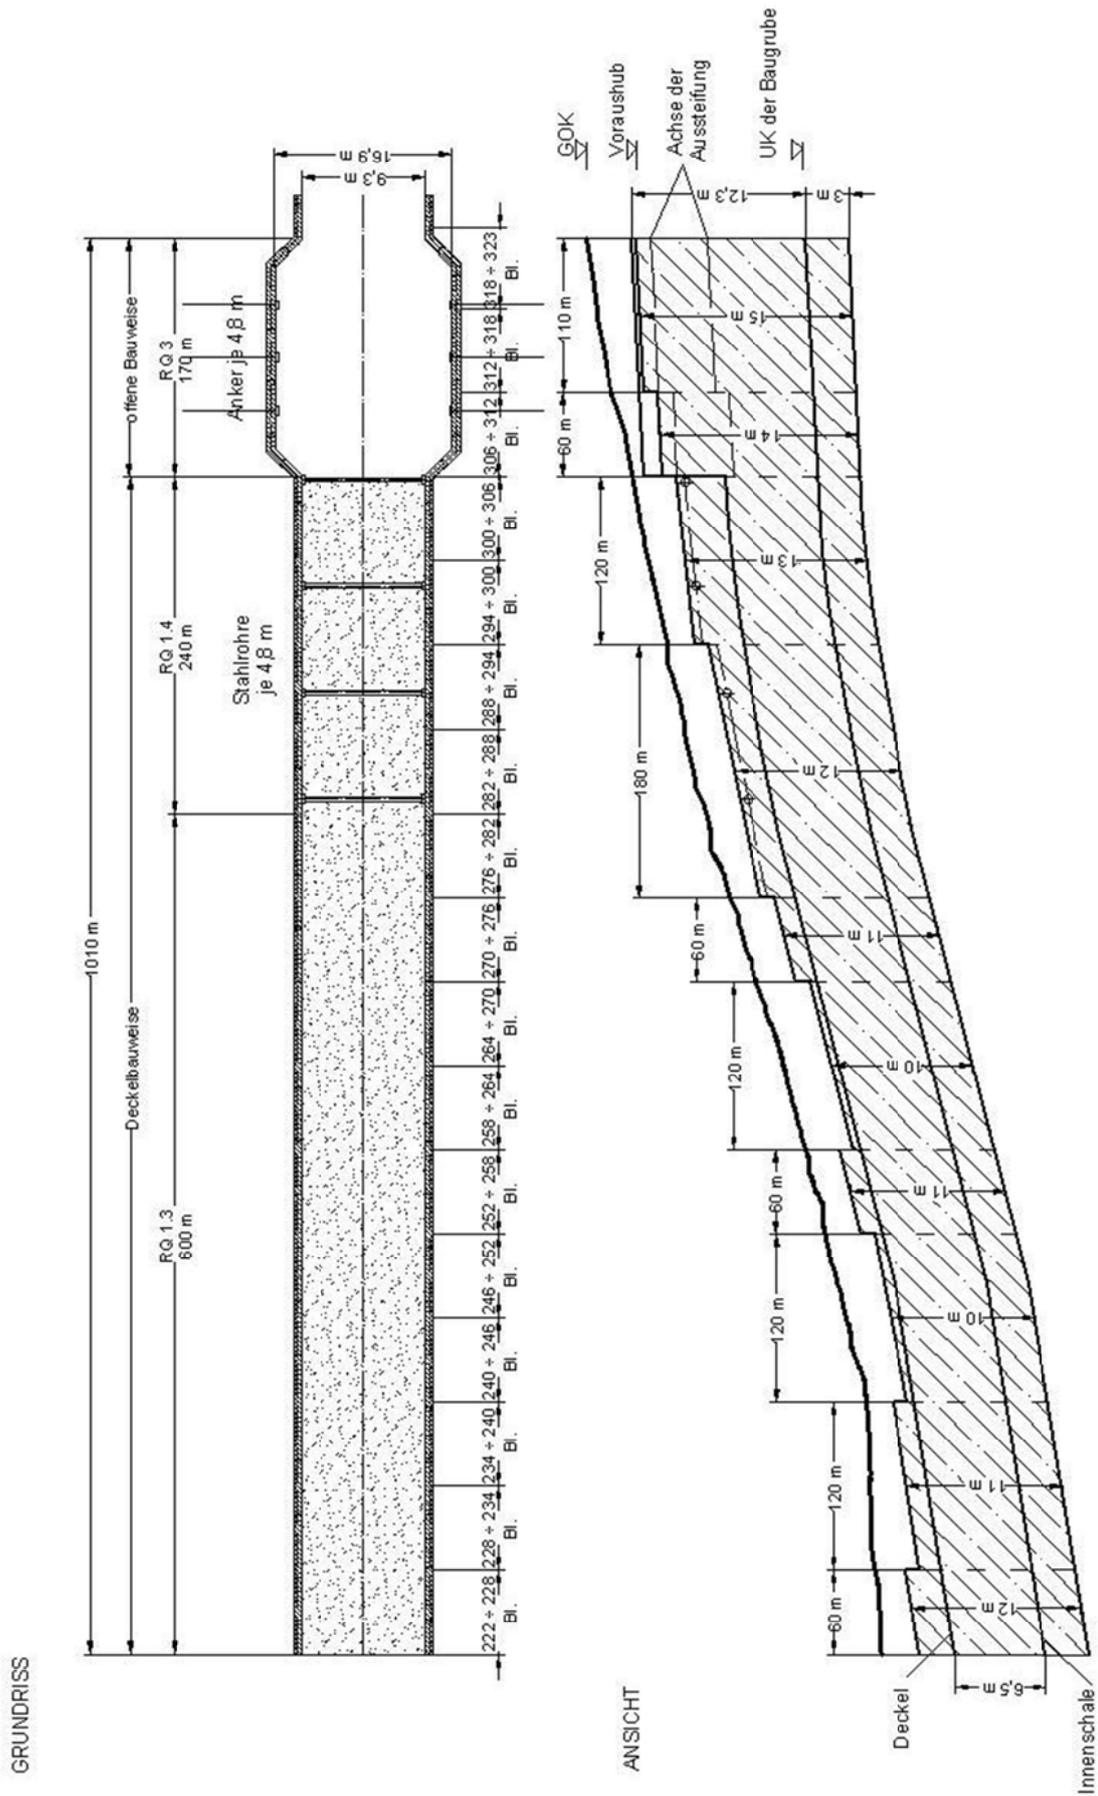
Grundriss und Ansicht des gewählten Bauleses (überhöht)
